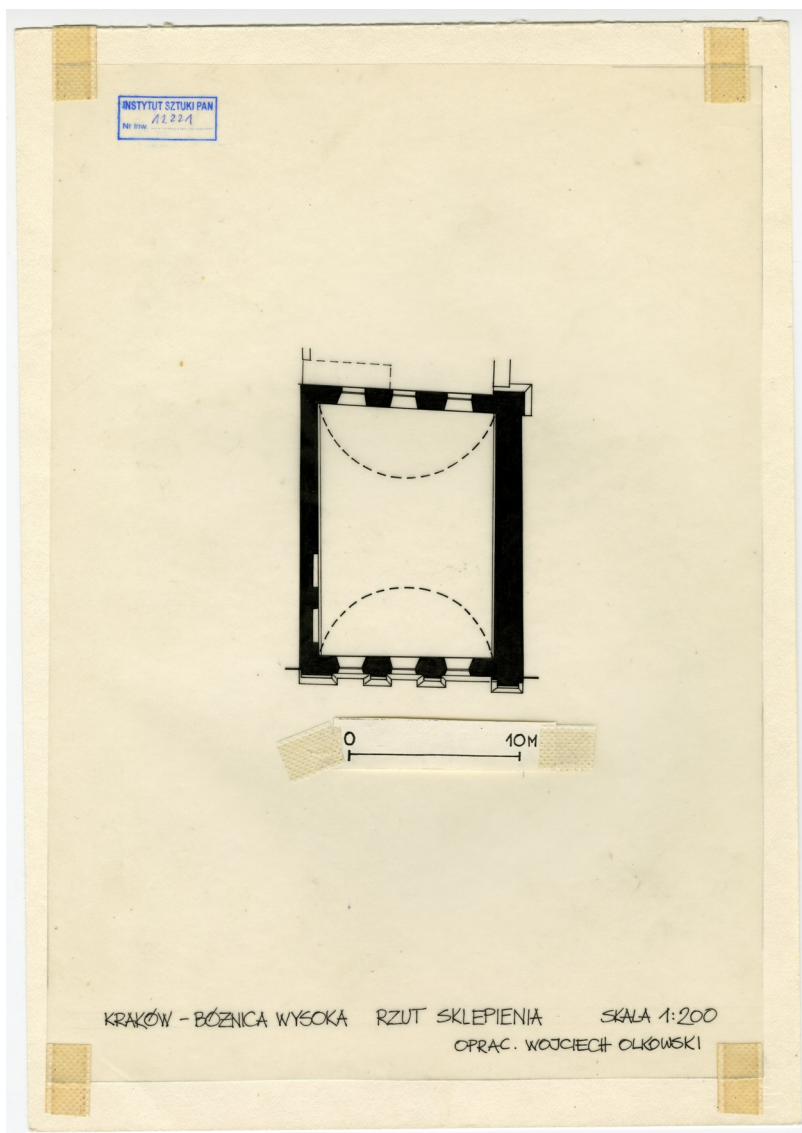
Grundriss OG, Fensterniveau, 1960er Jahre
